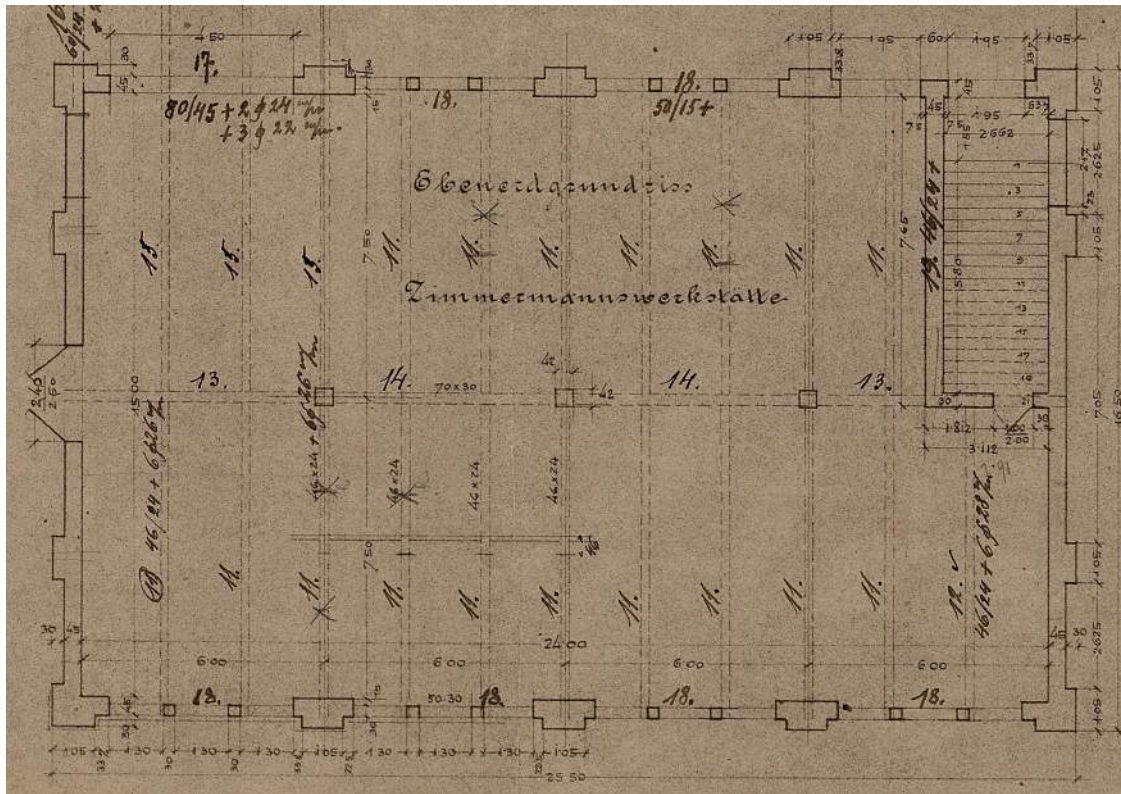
Erdgeschoßgrundriss des Originalplanes von 1917
